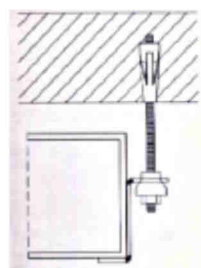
Sospensione di condotta rettangolare di piccole dimensioni (< 800 mm.) distanziate dal soffitto
